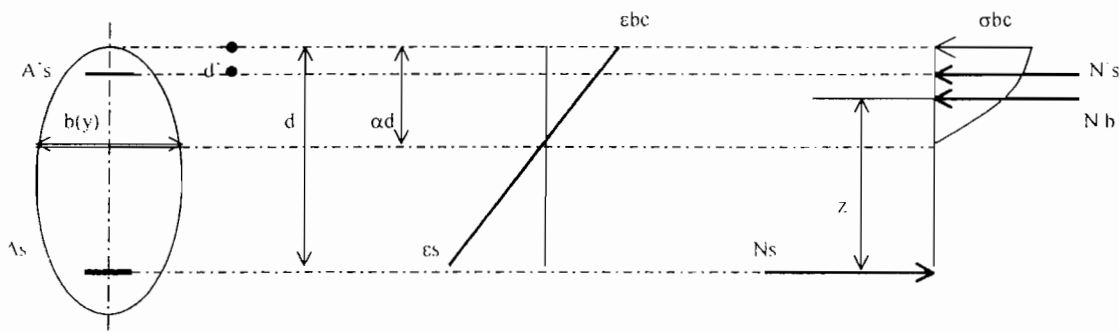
Modélisation du comportement d'une poutre sollicitée par un moment de flexion M_u
